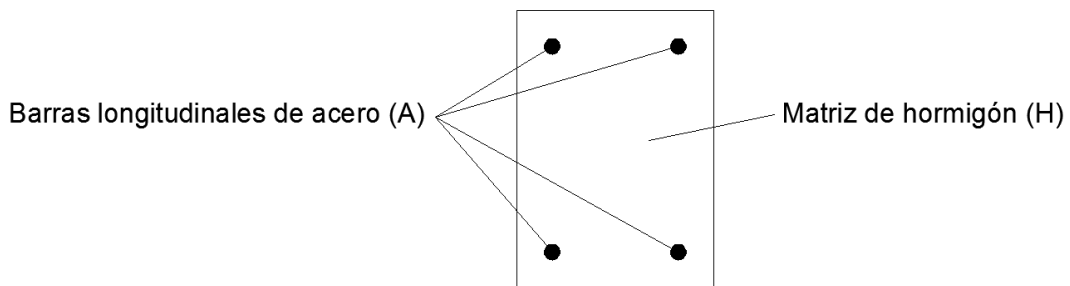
Esquema de la sección de la barra de hormigón armado sin cercos
